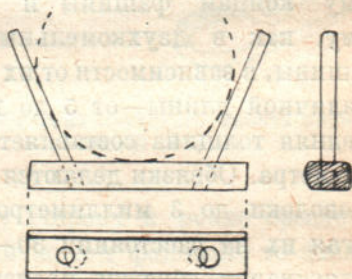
Конструкция станка для изготовления тяжелой фашины.
